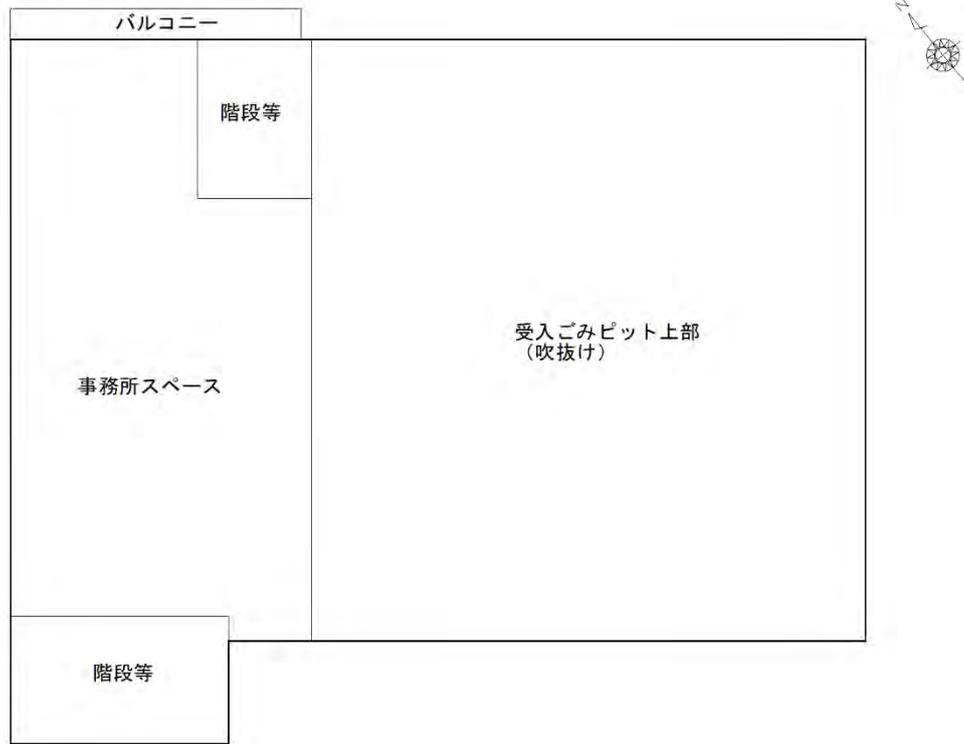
(7) 廃棄物受入棟平面図 (6階)
